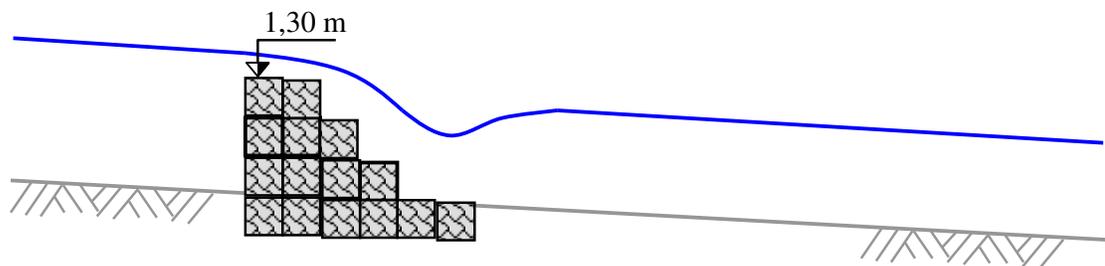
Esquema do vertedor do canal auxiliar localizado a montante da av. Automóvel Clube.
